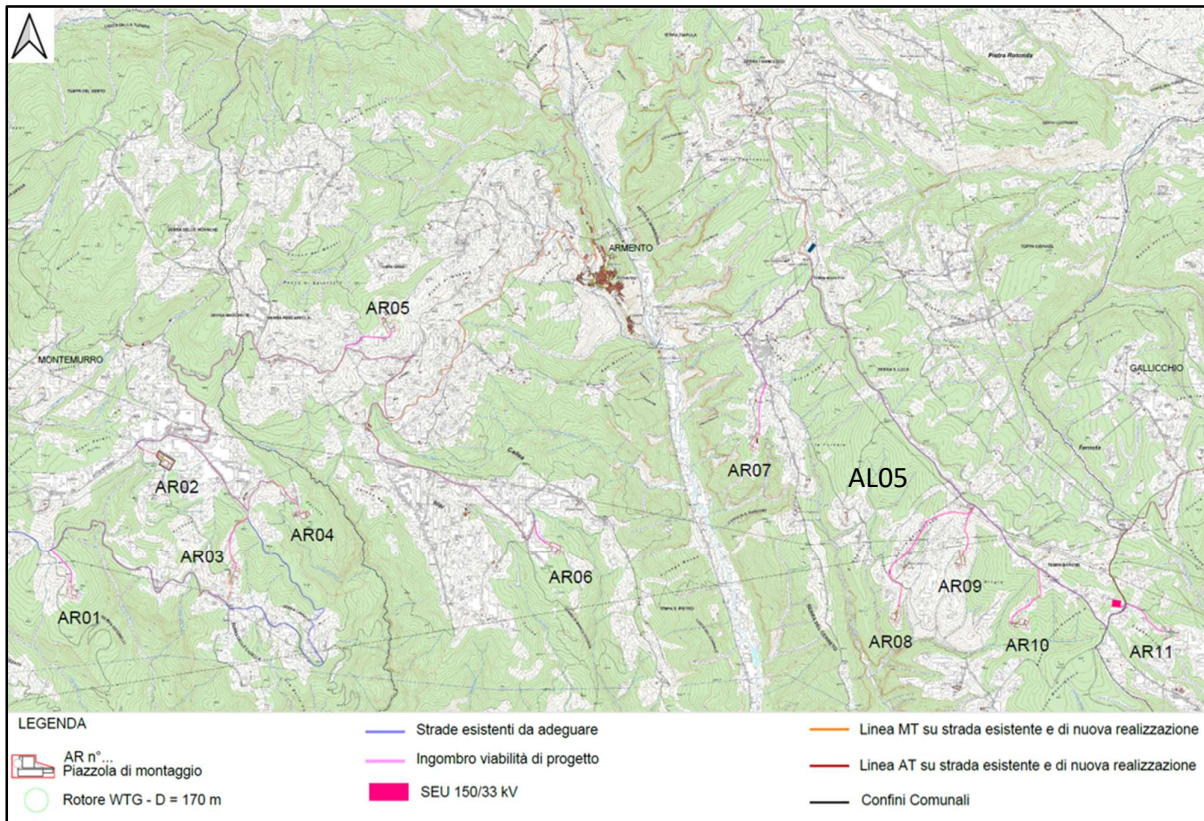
Layout d'impianto con viabilità di progetto e linee elettriche MT su CTR
